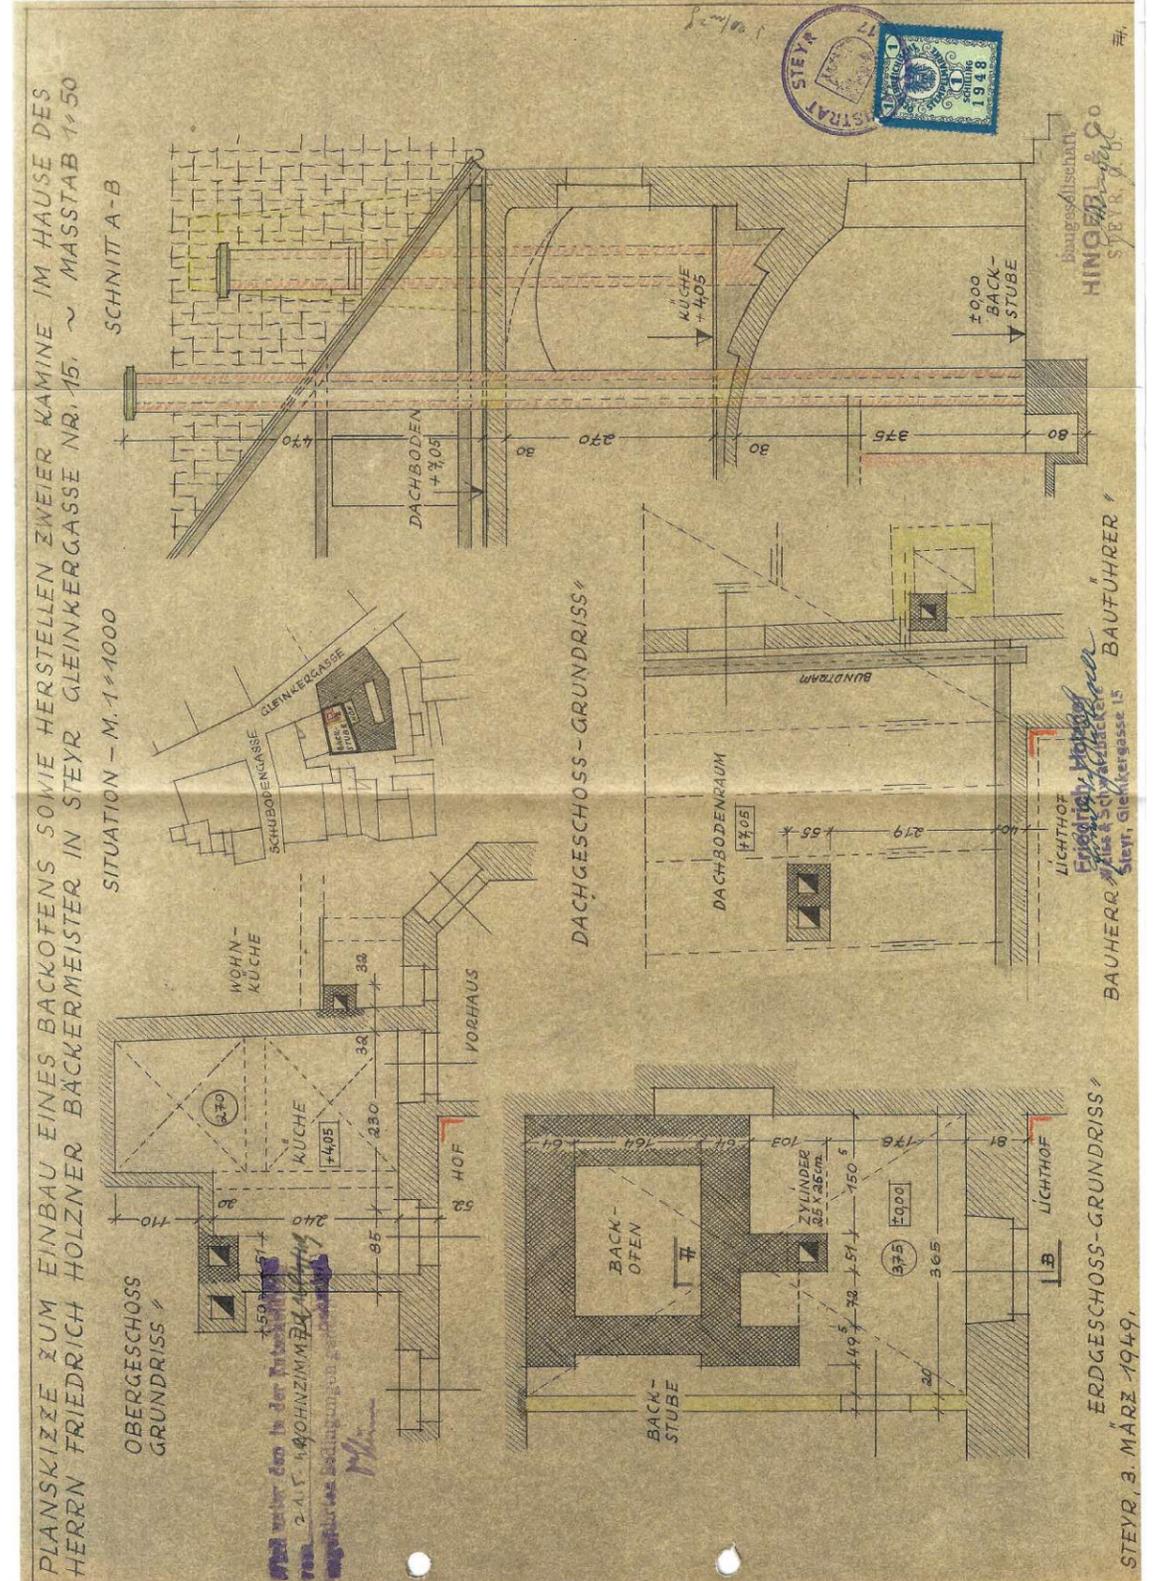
Plan für den Einbau eines Backofens und zwei Kamine
